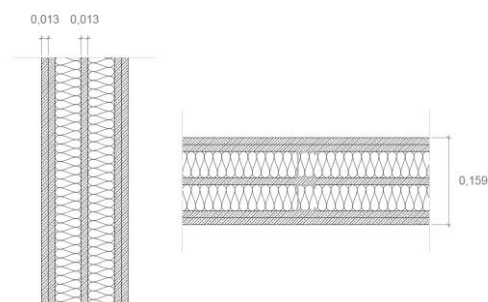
parede divisória dupla em estrutura leve, com 159 mm de espessura
